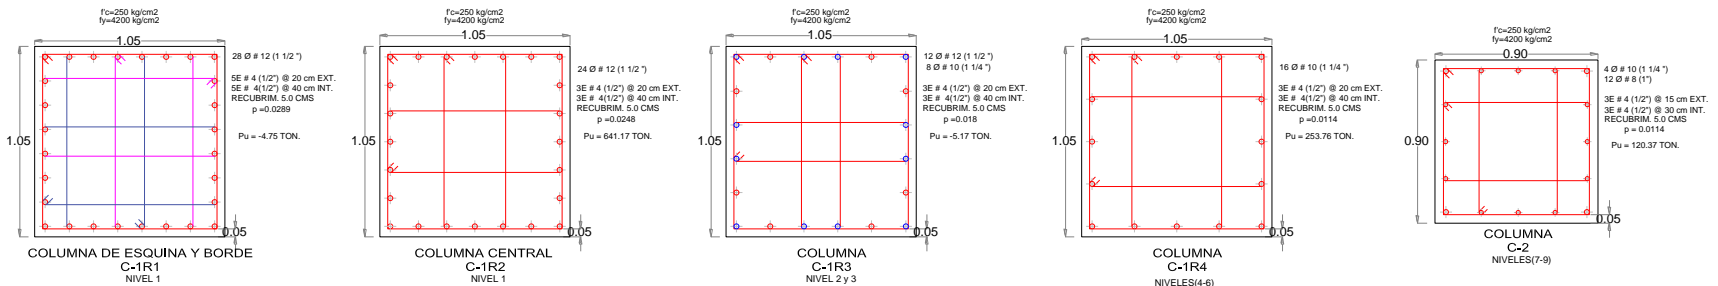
Detallado de armado de columnas de edificio de 9 niveles con base a la hipótesis de las NTCC-04.
